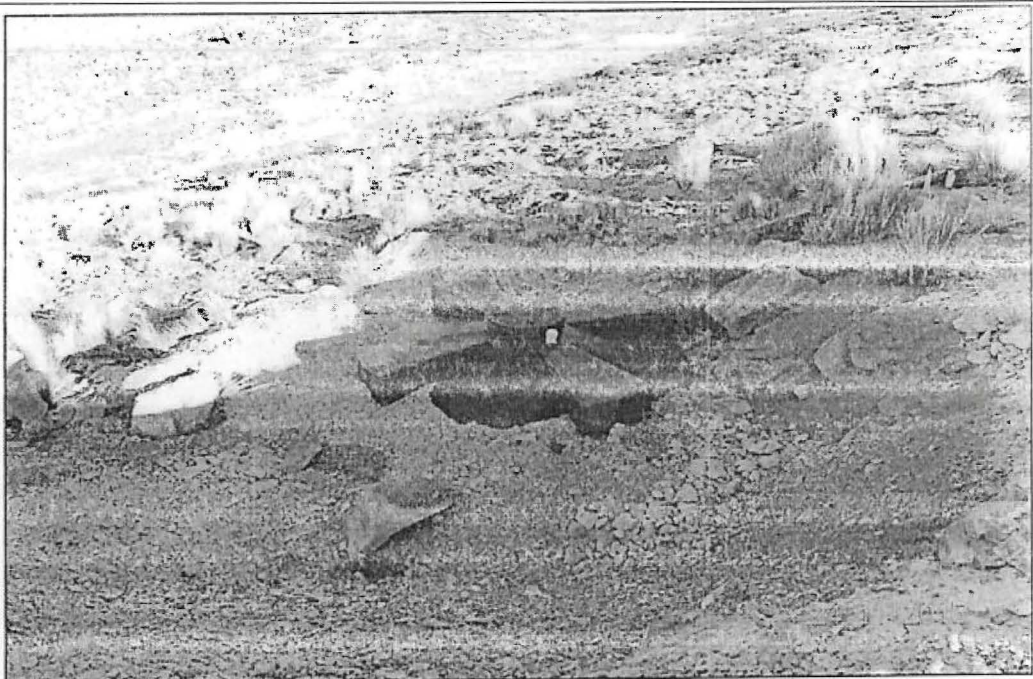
HALLAZGO DE GABINETE Vista del tanque biodigestor. Coordenadas (Datum GWS84) N 8384977, E 771452.
